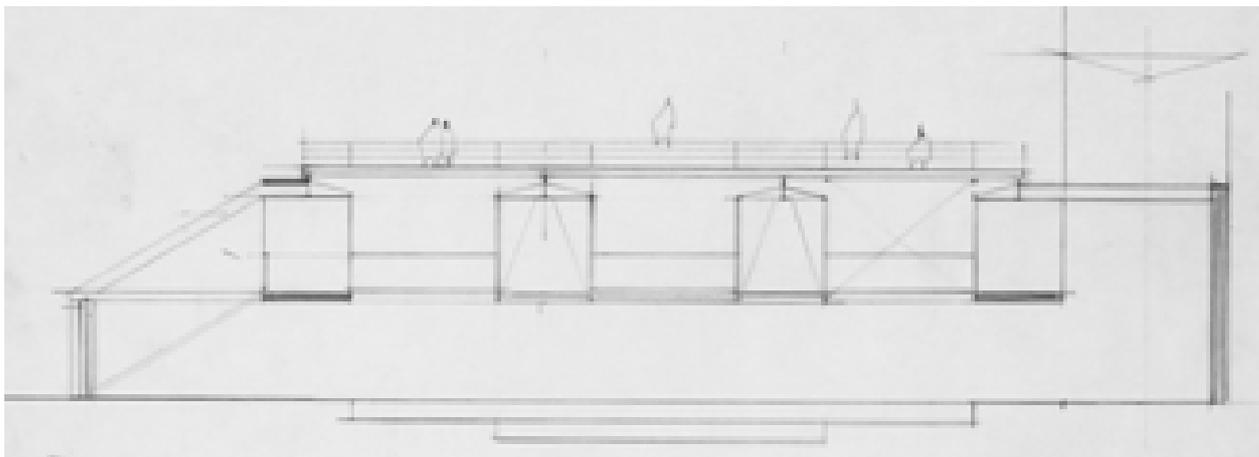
Studio sezione trasversale – progetto del 1974-1975 (AABS-95.063)
